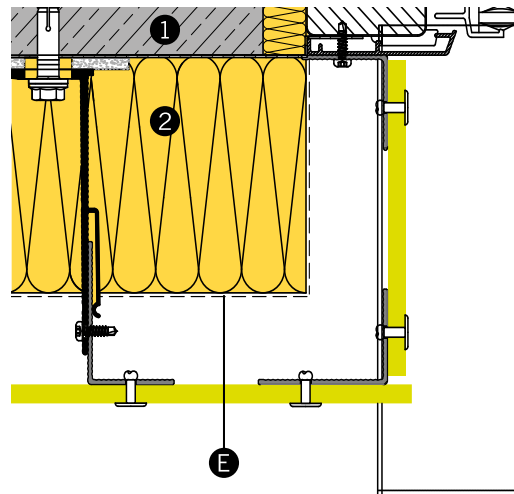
DETAILLERING: HORIZONTALE DOORSNEDES ALUMINIUM ACHTERCONSTRUCTIE GENAGELD
